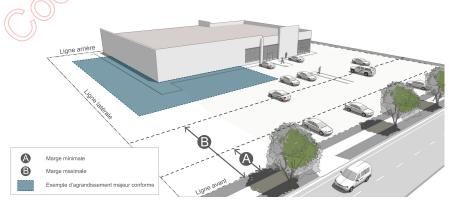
Agrandissement majeur d'une construction dérogatoire à la marge avant maximale
